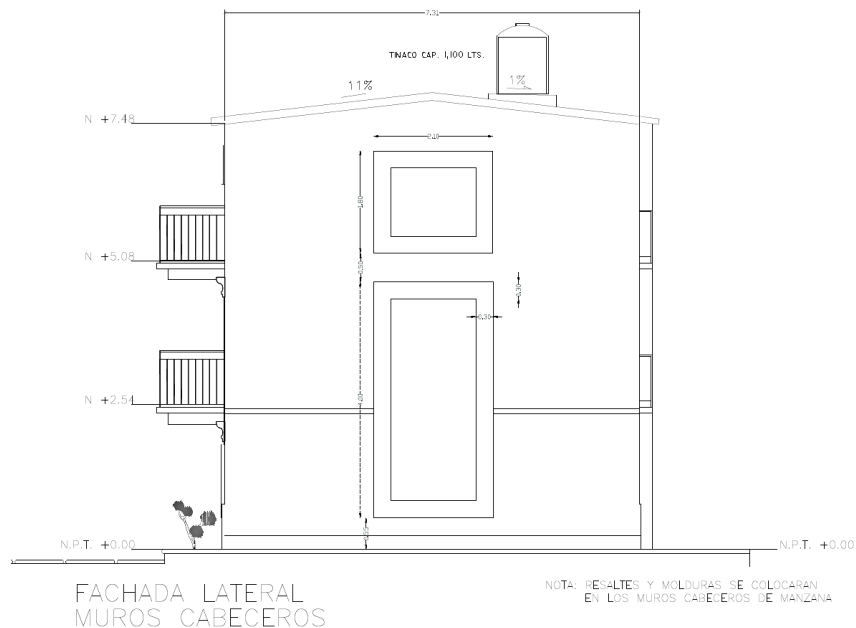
Fachada lateral del conjunto. Fuente: Registro Único de Vivienda
